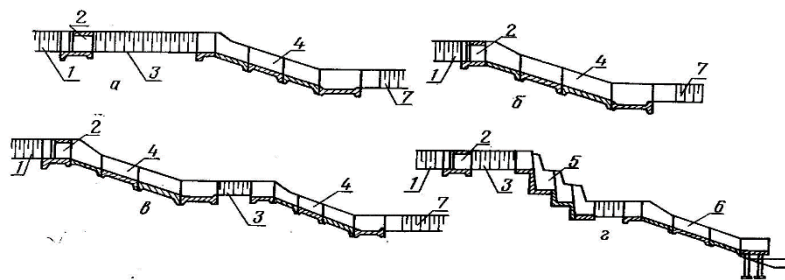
Примеры размещения сооружений на поверхностном водосбросном тракте: 1 – подводящий канал; 2 – шлюз-регулятор; 3 – сбросной канал; 4 – быстроток; 5 – перепад; 6 – консольный сброс; 7 – отводящий канал
